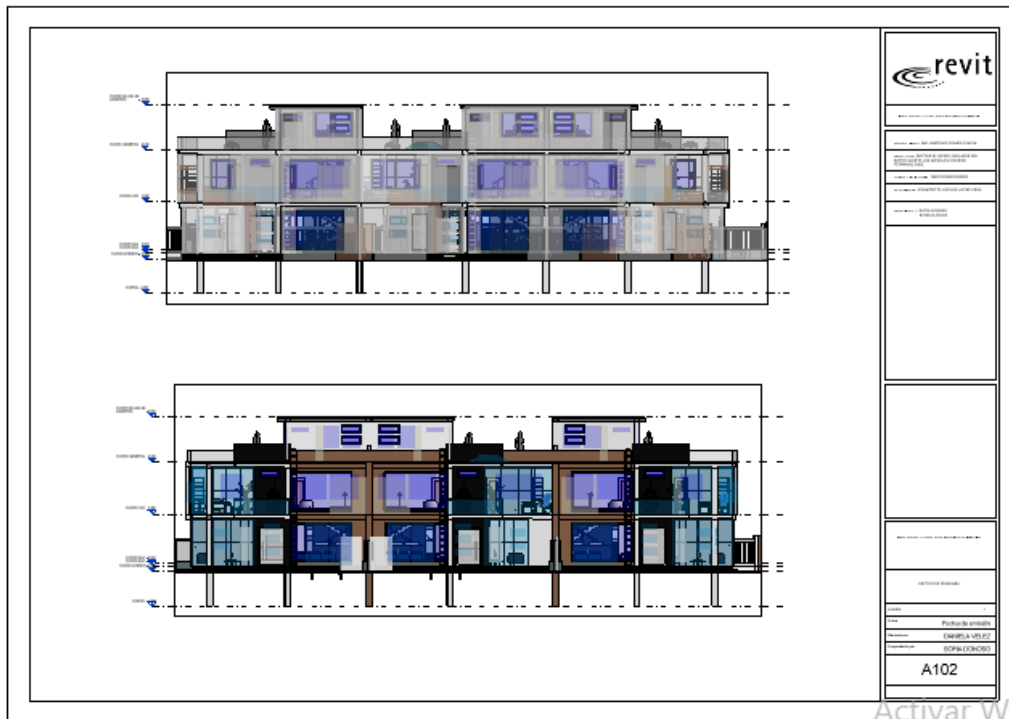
Plano de arquitectónicos, Vista frontal y posteriores
